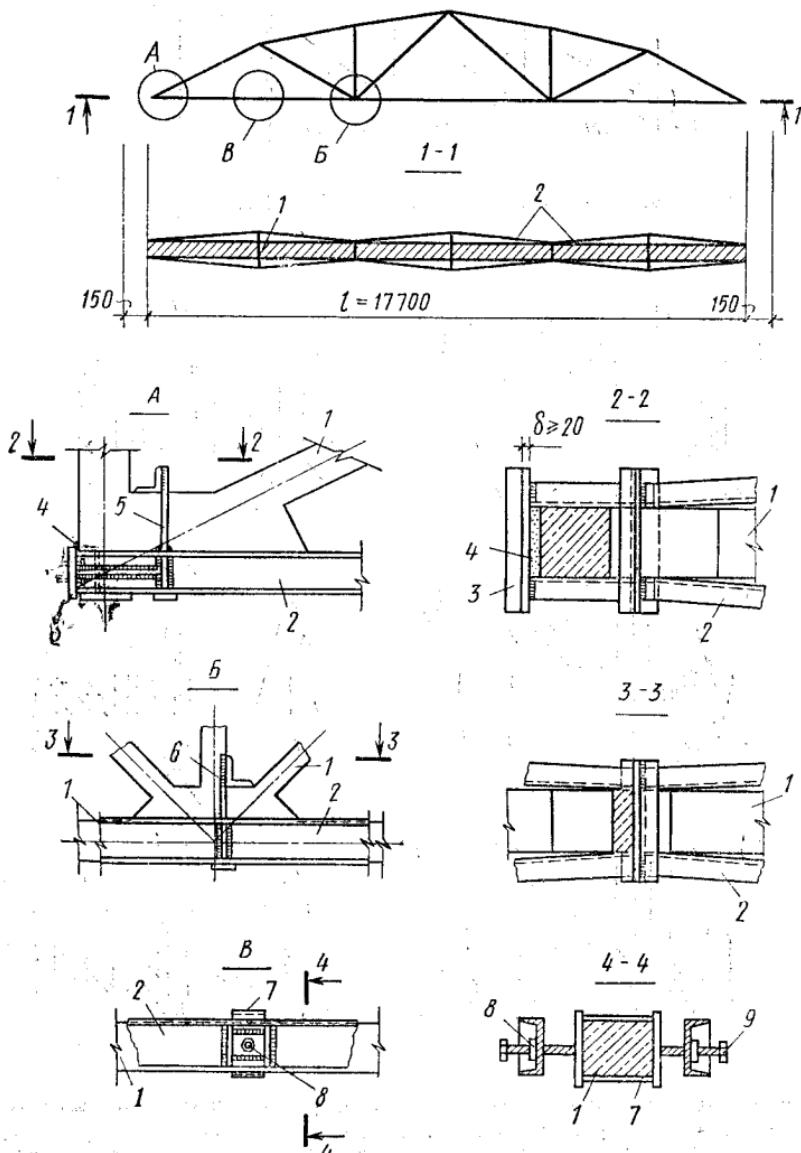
Усиление нижнего пояса стропильной фермы затяжками из швеллеров:
